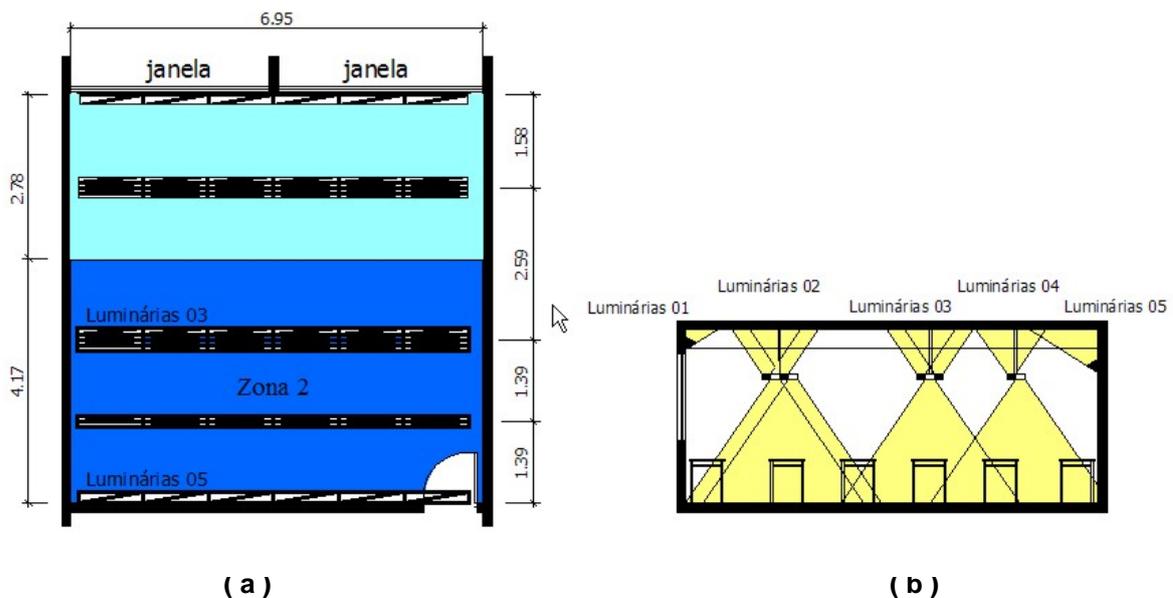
Planta baixa (a) e Vista (b) com localização de luminárias.
